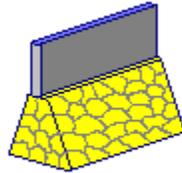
Zapata Corrida, Mampostería, Interna o No Colindante
